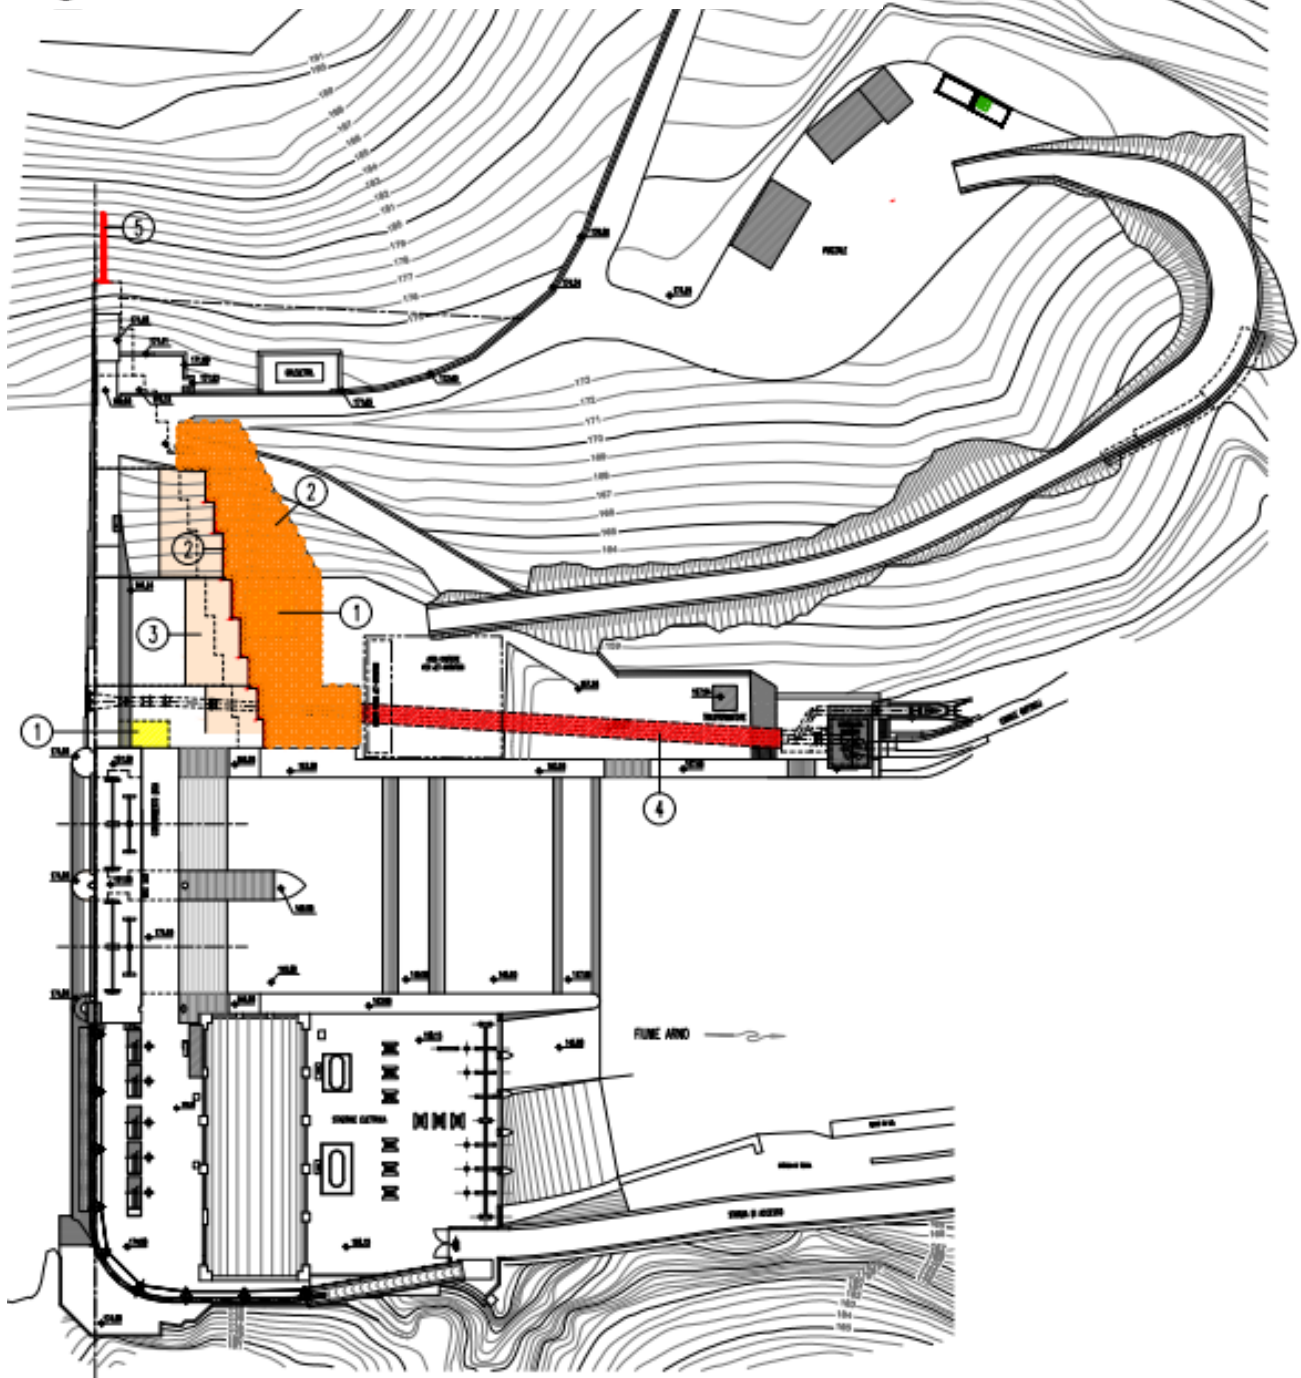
4 – Estratto planimetrico elaborato progettuale – Cantierizzazione FASE 4a
